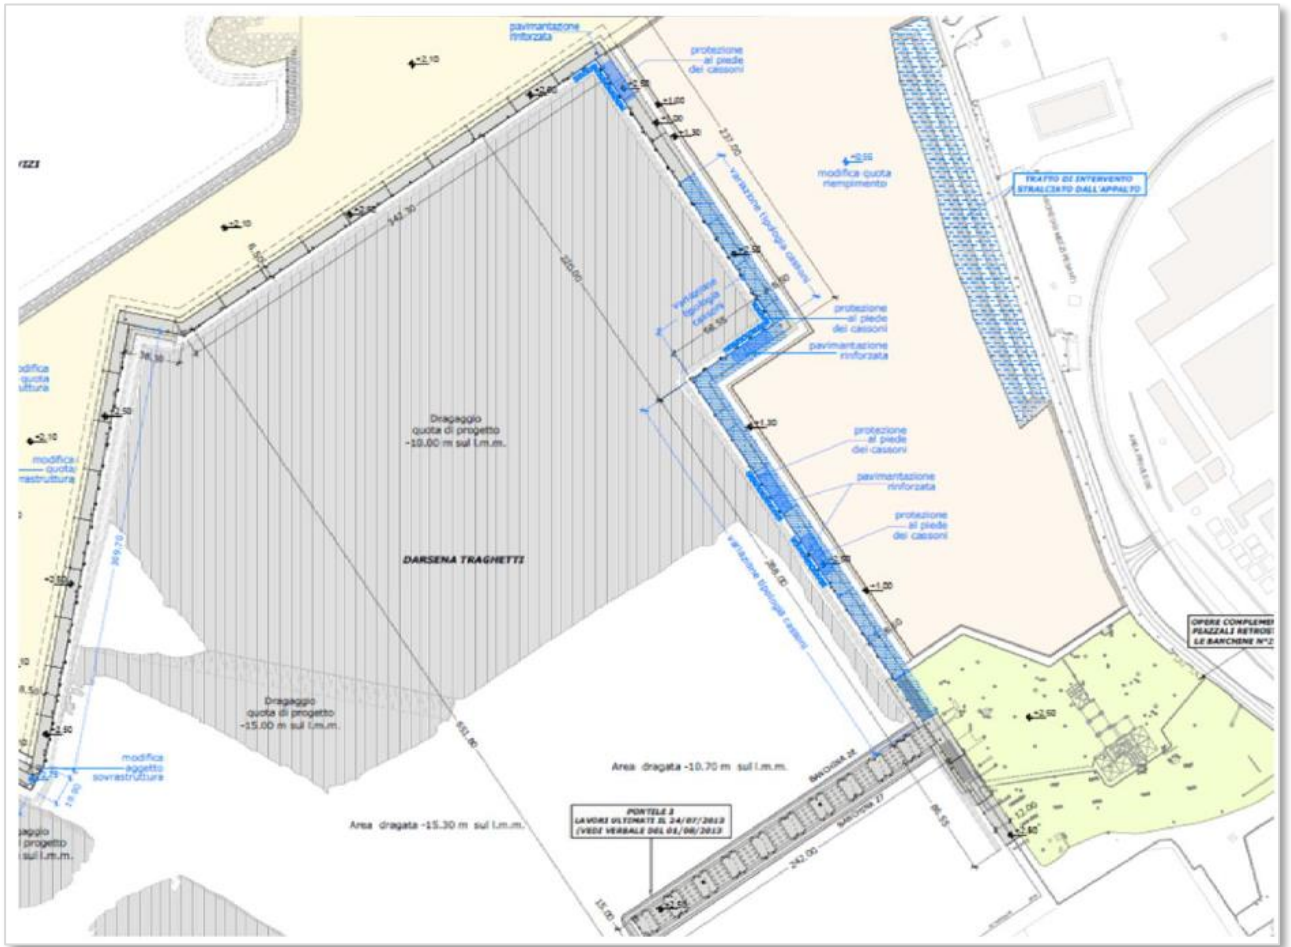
Nuova planimetria della Darsena Traghetti
